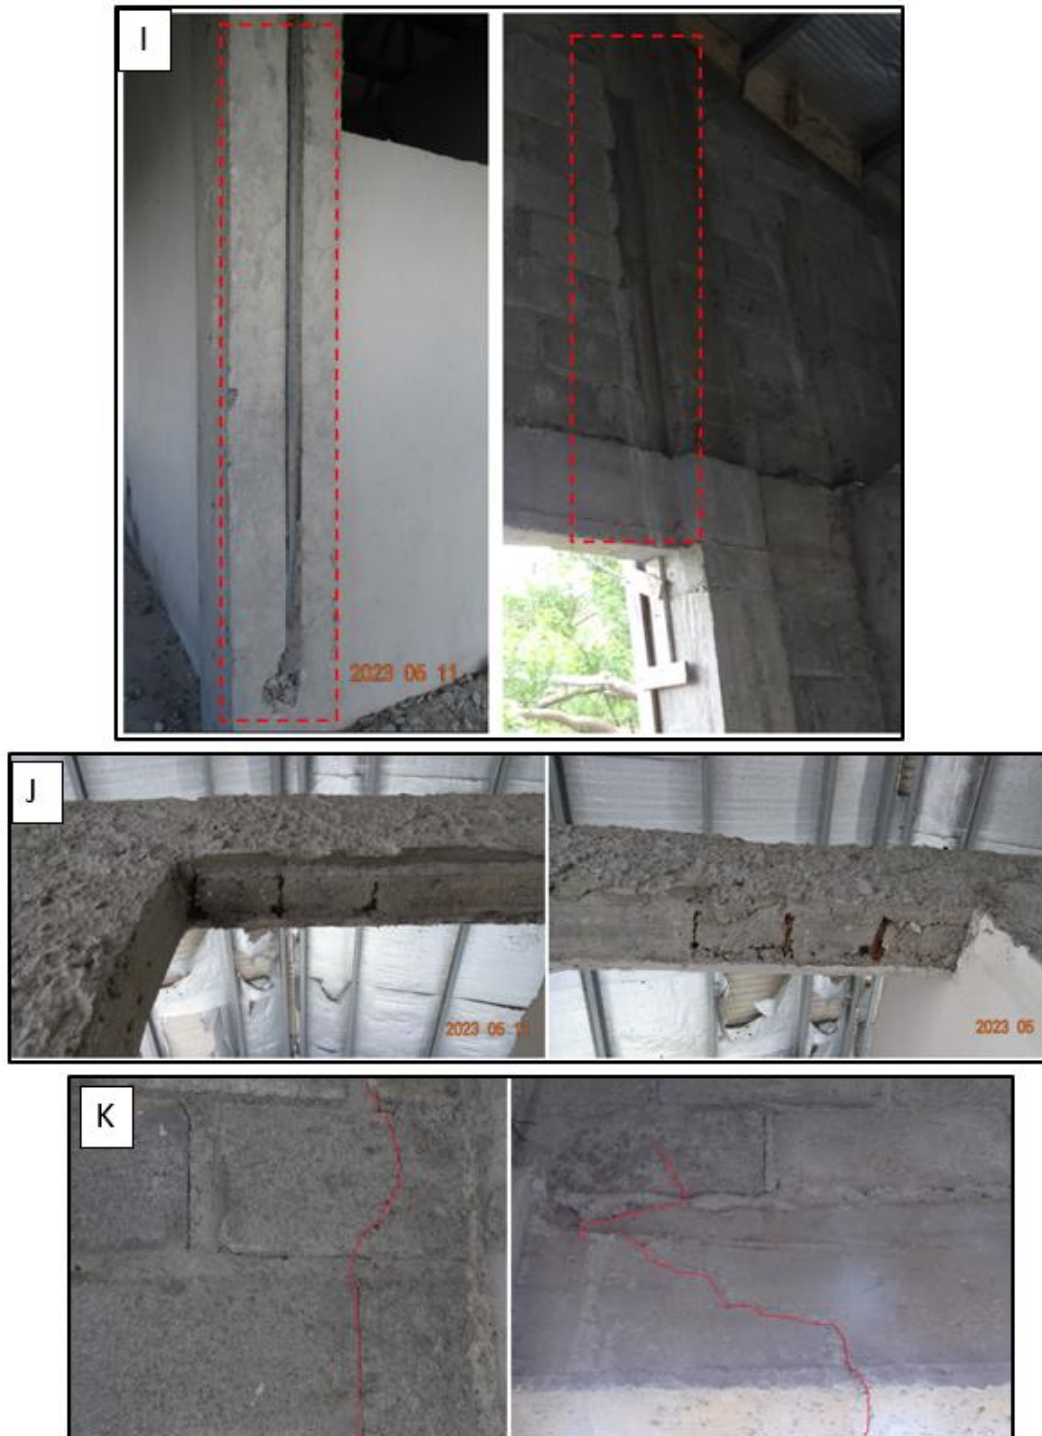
Deficiencia constructiva de (I) Prevista eléctrica embebida incorrectamente, (J) Viga con pérdida de recubrimiento, (K) Viga y muro con agrietamiento en zona cercana al tapichel, del edificio de aulas no.3 del CTP José María Zeledón Brenes
